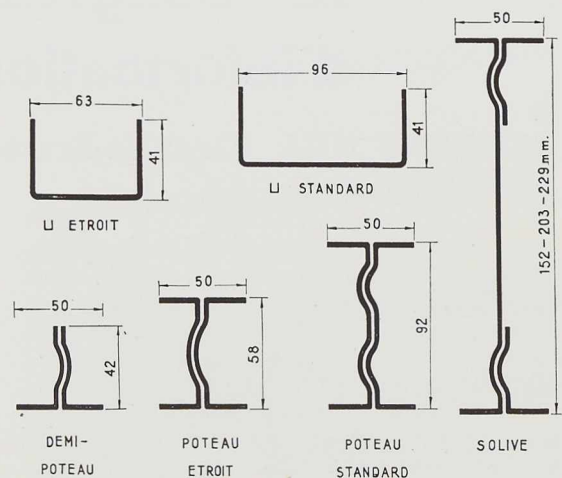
Divers types de poutrelles « Stran-Steel ».
